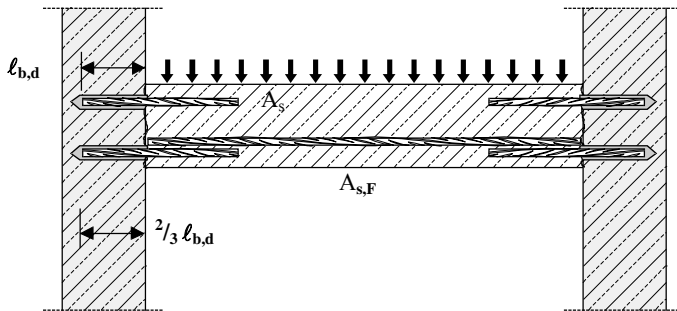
Ancrage direct d'armatures en extrémité de dalles ou poutres, simplement appuyé
